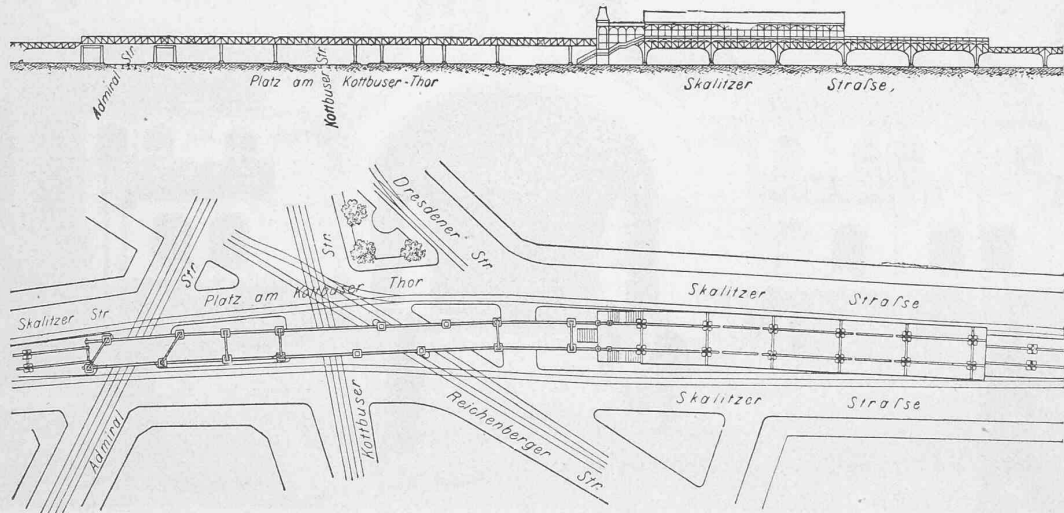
Haltestelle Kottbusertor. — Ansicht und Lageplan. — Masstab 1 : 1500.
